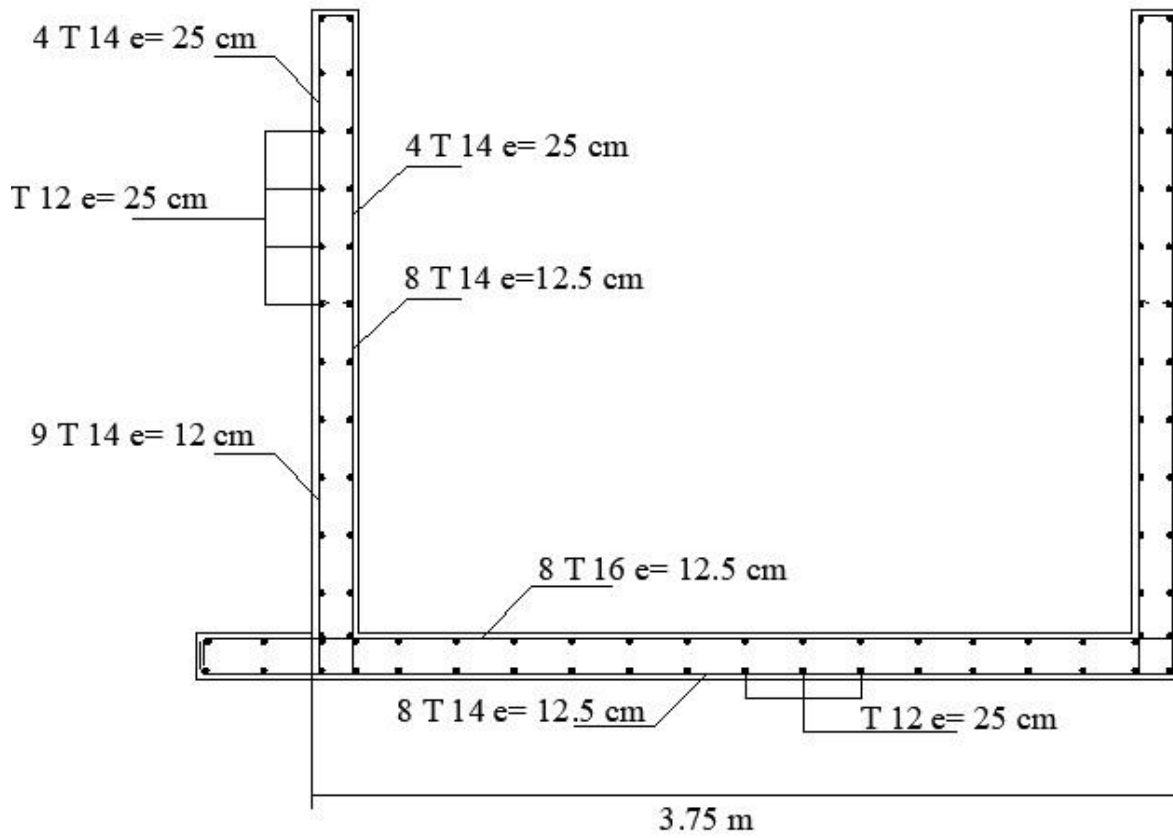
schéma de ferrailage de 1<sup>ère</sup> tranche (consol + traverse) du réservoir.
